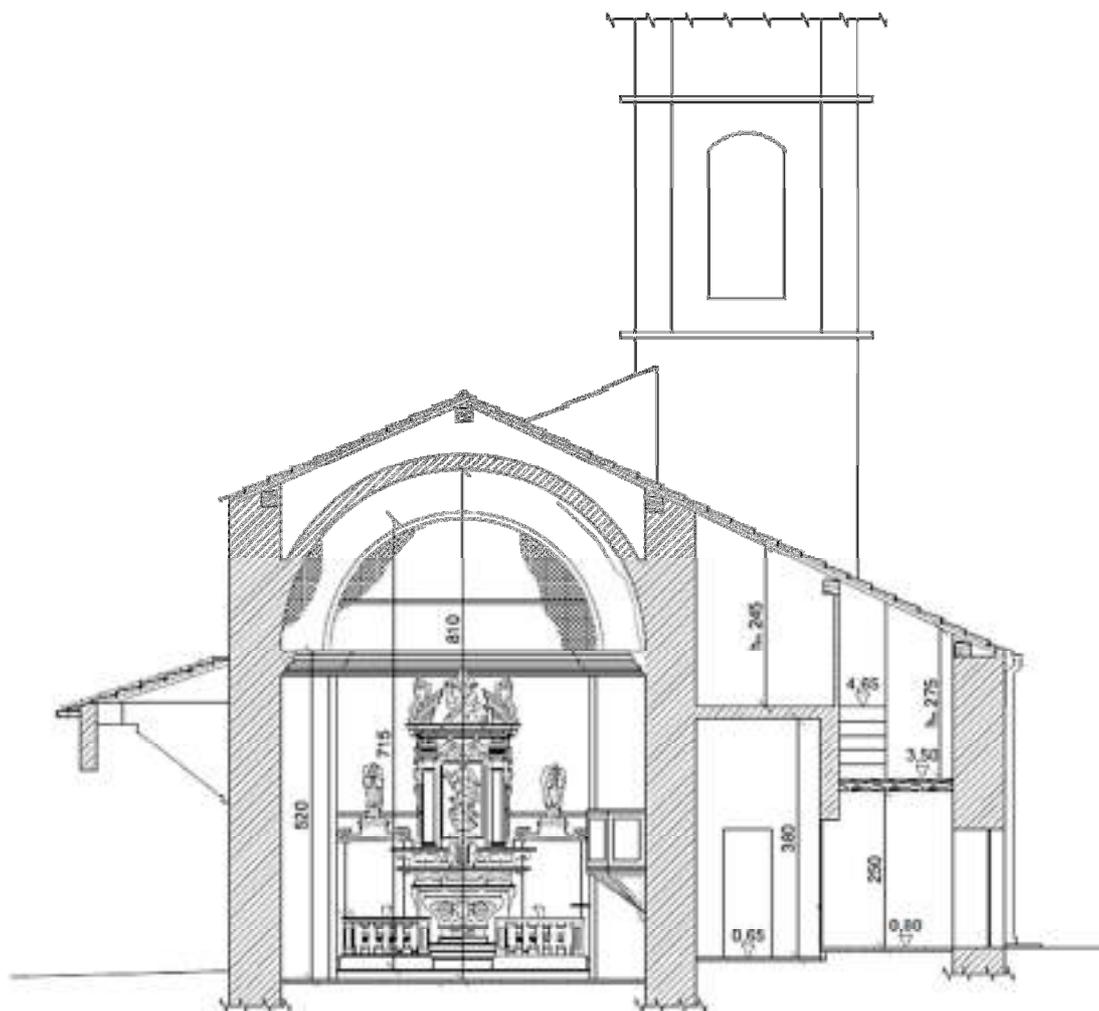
Sezione trasversale A-A (Fonte: Tavola 3E)
